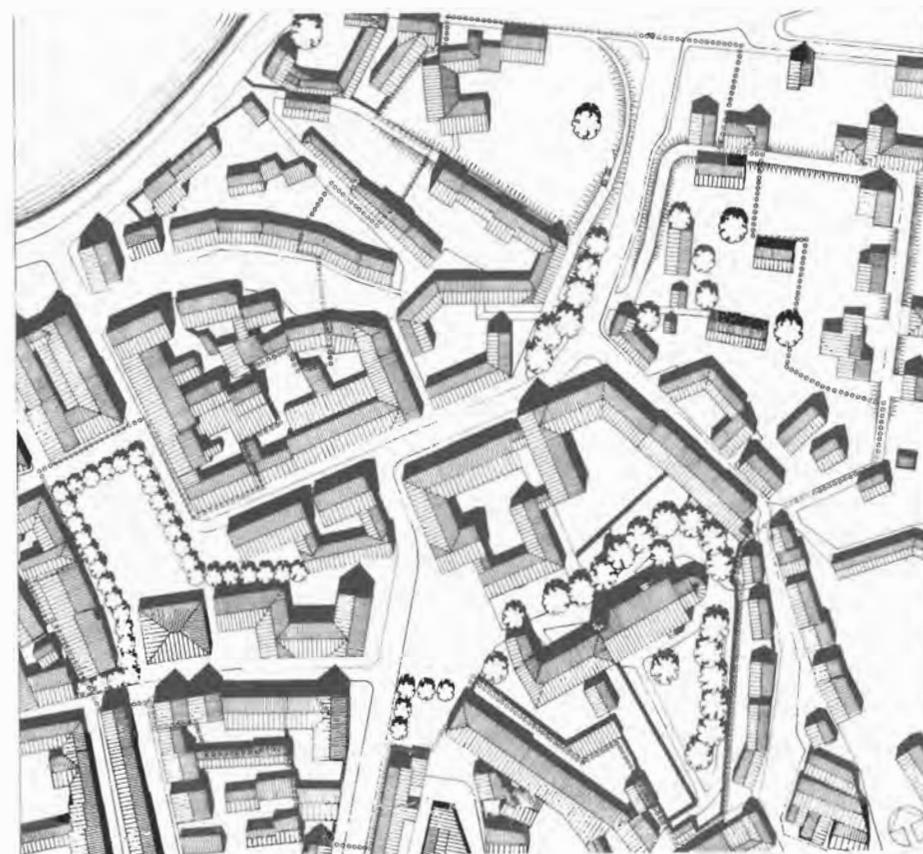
Baukörper- und Dachstruktur nach Durchführung der Sanierungsmaßnahmen 1983; Gaenssler/Hugues; durch eine eindeutige Ausformung der Straßen, Plätze und Baukörper gewinnt die stadträumliche Struktur wieder eine feste Ordnung
